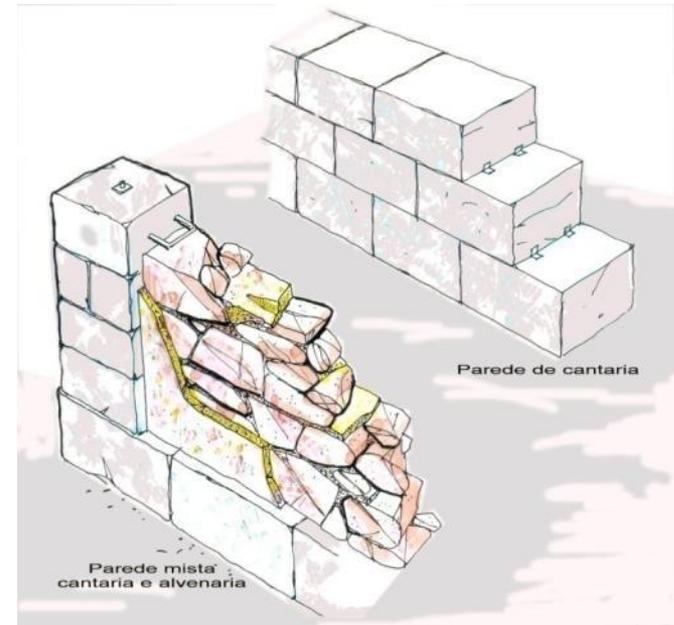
Exemplo de Parede de Cantaria e Parede Mista de Cantaria e Alvenaria
